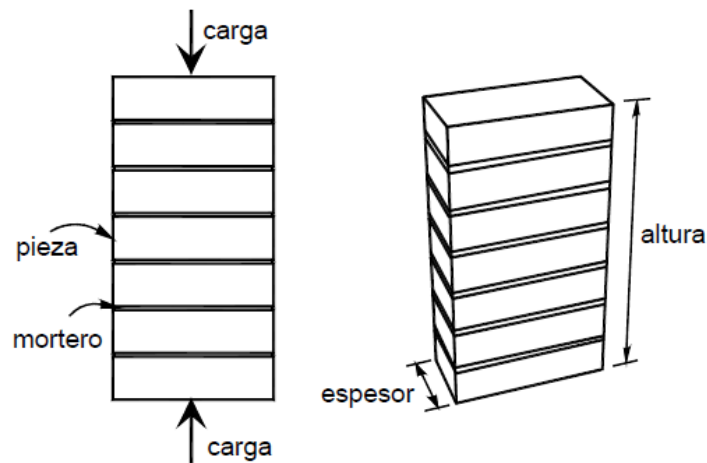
Ensaye de pilas de mampostería sujetas a compresión
